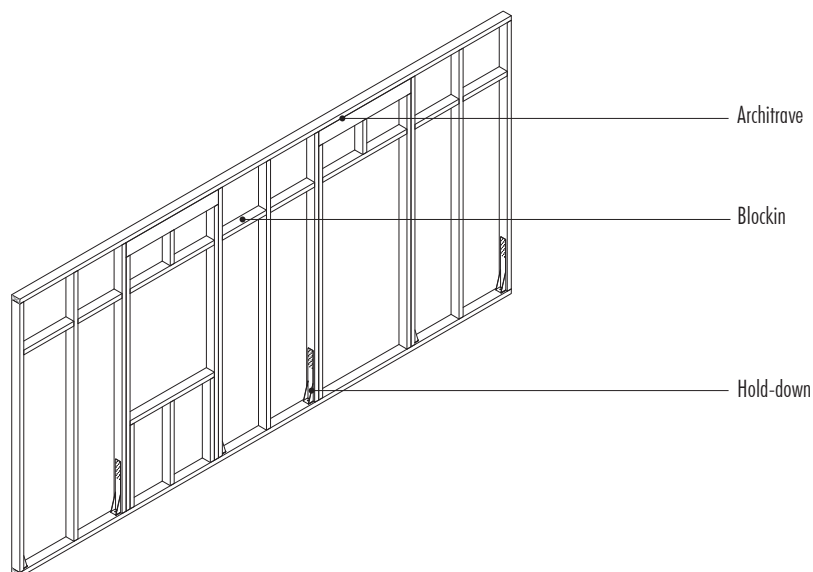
Dettaglio del telaio della parete con aperture per porte e finestre.
